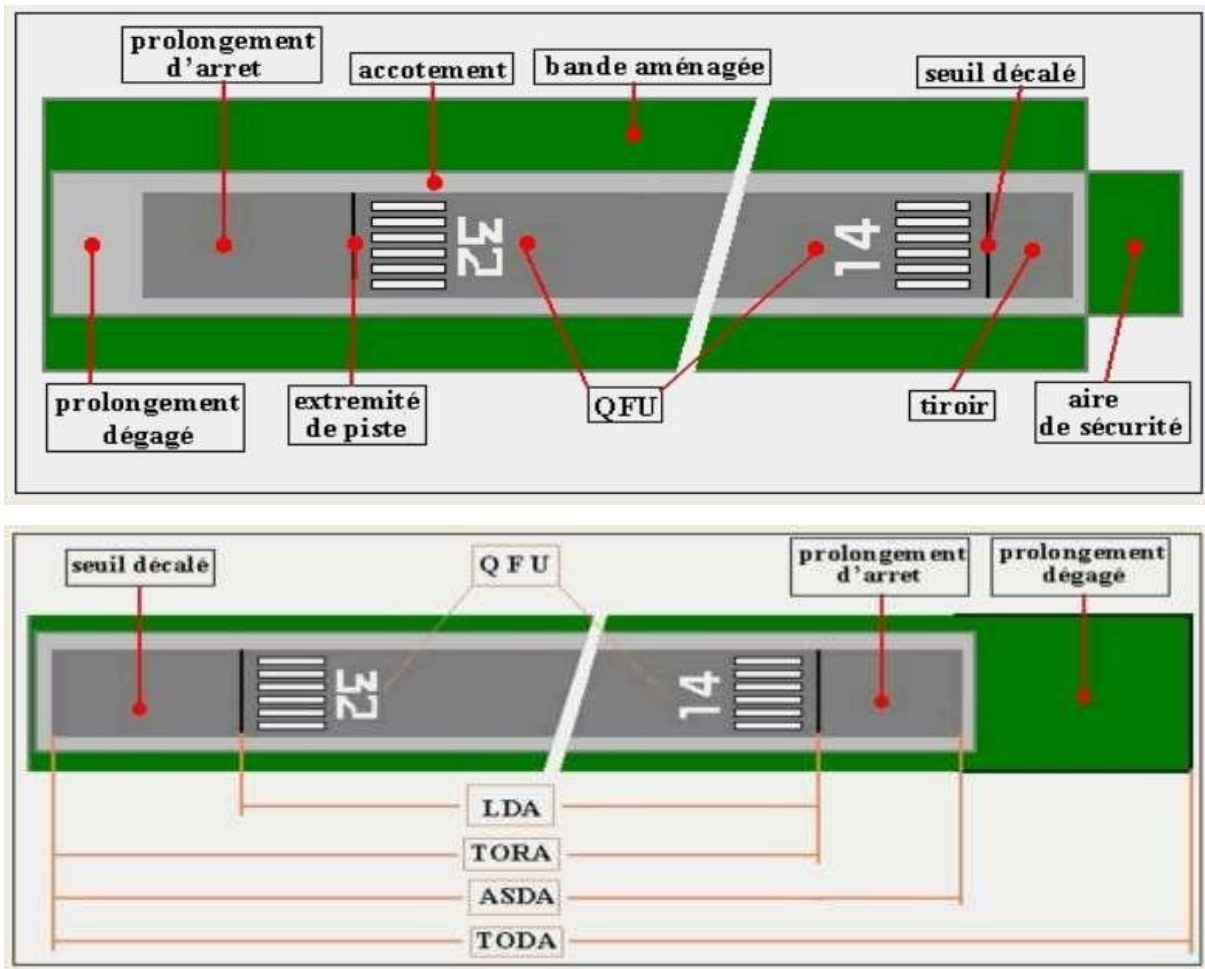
Exemple plus détaillée d'une piste. [5]
